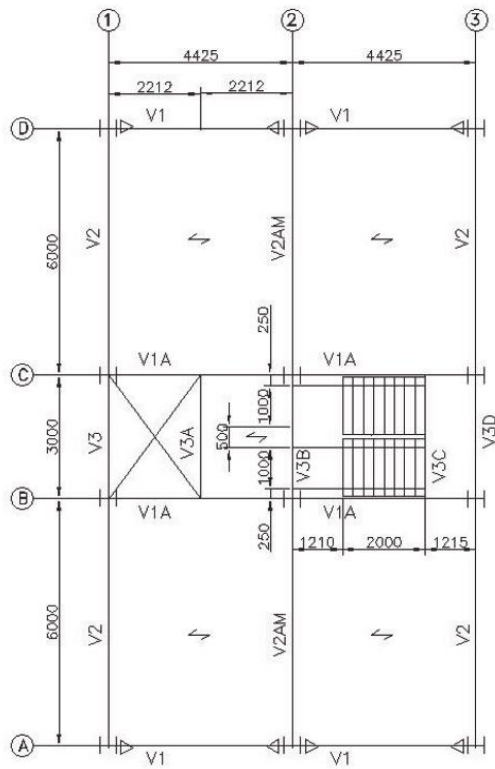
Plano da Vigas EL +3000 a +9000 - CBCA
